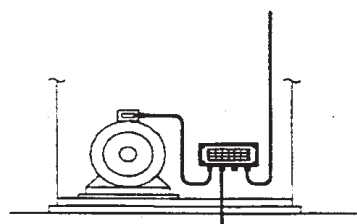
SURTIDOR CON CABEZAL ELECTRÓNICO ELEVADO Y ADOSADO A LA COLUMNA DE MANGUERAS (BARRERA DE VAPOR TIPO 1)
